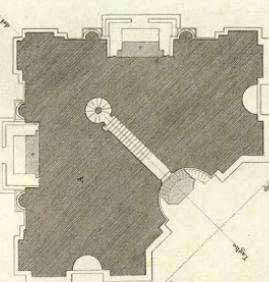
1. Prospetto del Pilaone con i suoi dettagli
